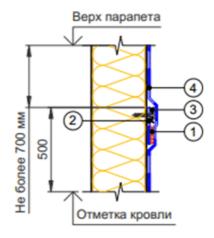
Примыкание кровли к стене с механическим креплением края кровельного ковра:
